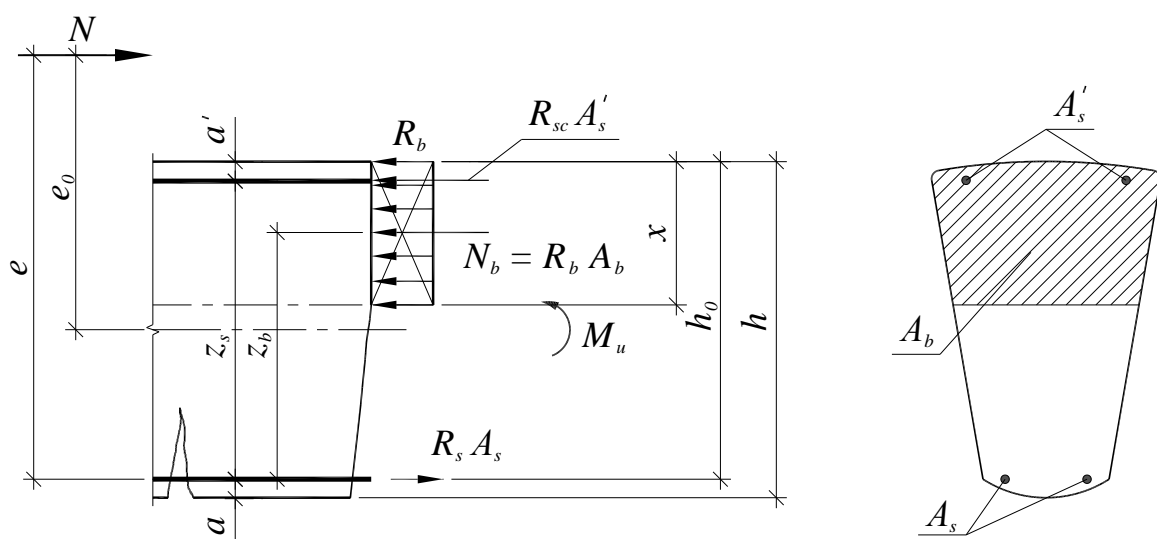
Усилия в сжатом железобетонном элементе.
